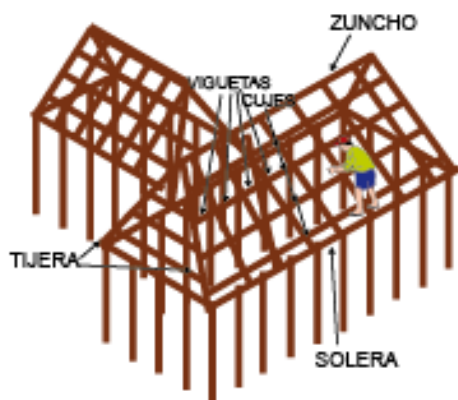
Subestructura en Madera, Fuente adaptado de (Wilches, 2009)
